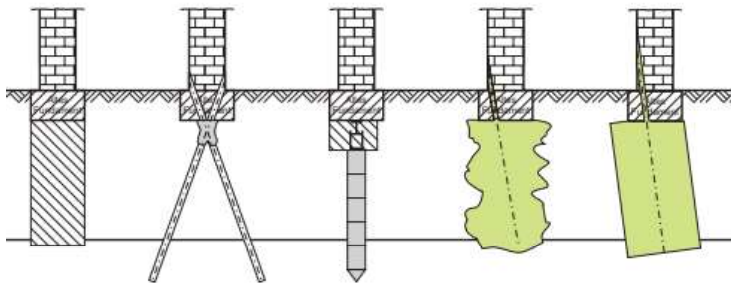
Typiske refundamenteringsmetoder (venstre til høyre): understøping, mikropeling, sementinjeksjon, jetpeling
